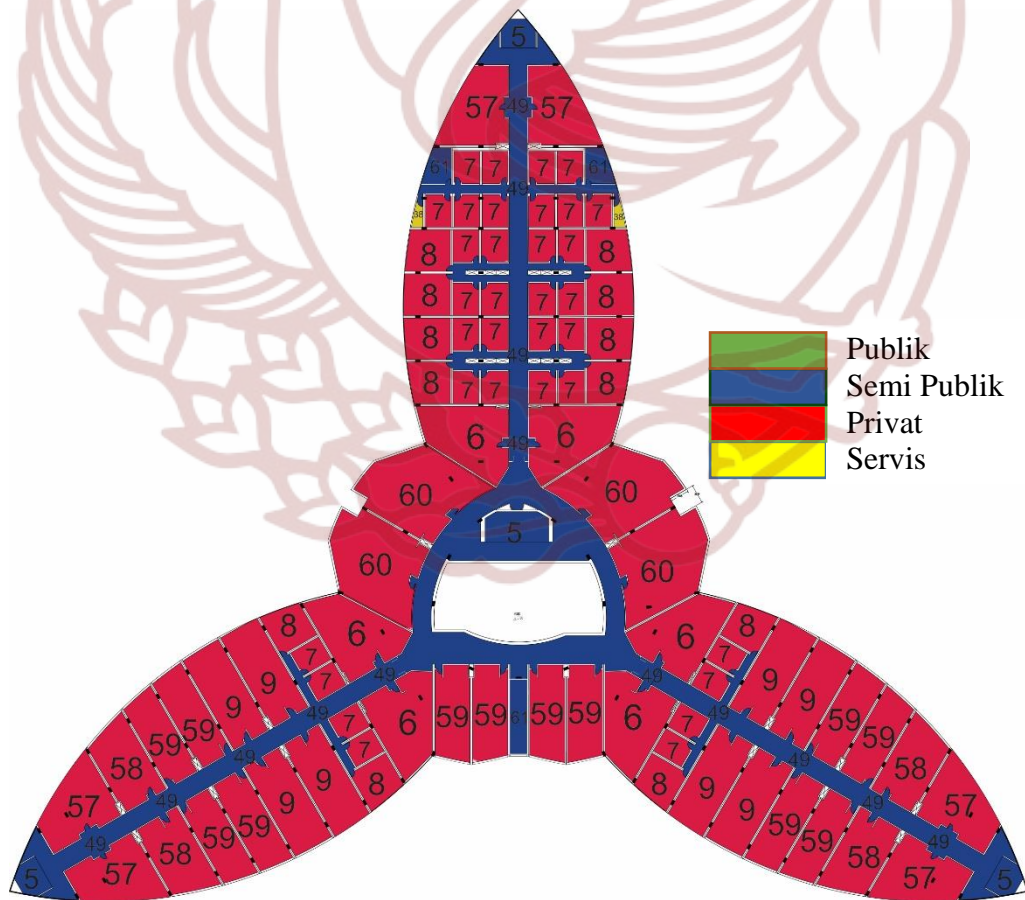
Zoning Grouping Lantai 2, Alternatif 1
